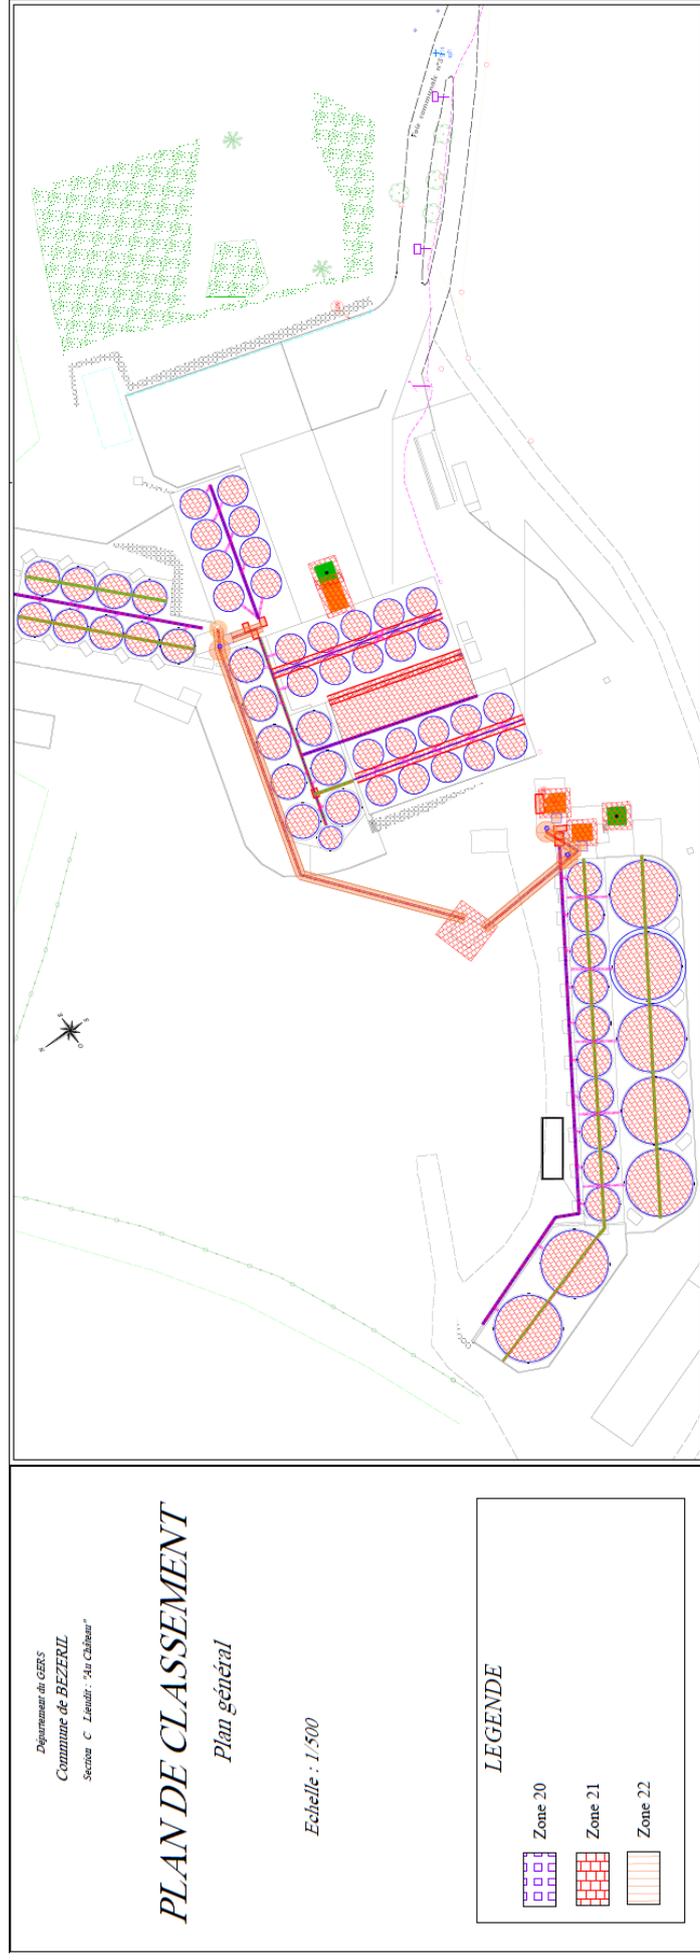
Plan de situation du zonage ATEX sur le site de La Régie
